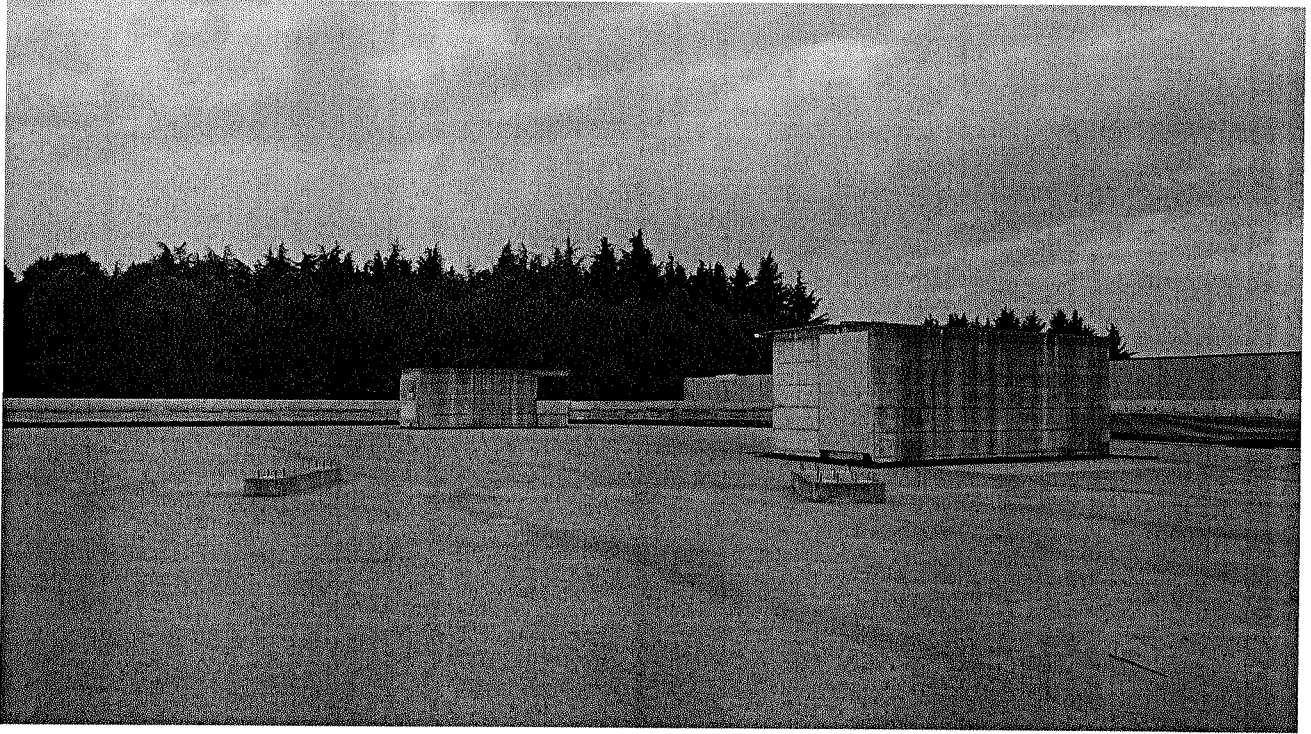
vista della copertura con basamenti per ancoraggio collettori solari
